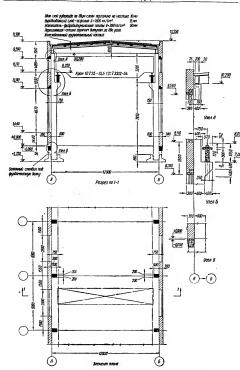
Однопролетное промышленное здание в сборном железобетоне.
